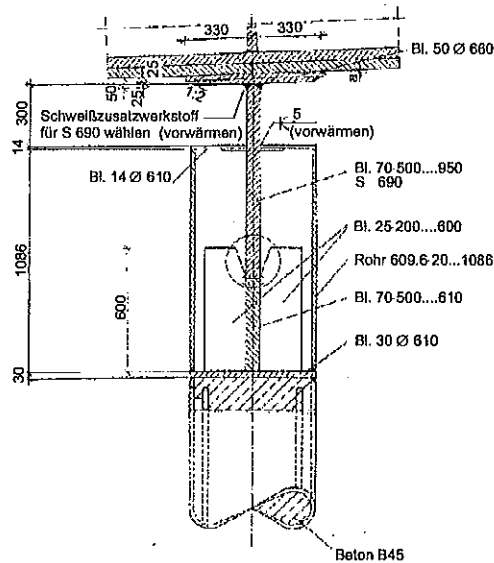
Pile et connexion pile-poutre pour le pont d'Ingolstadt
